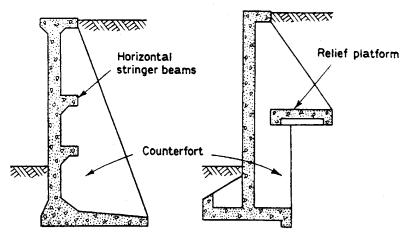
شكل الحوائط الساندة ذات الدعامات
